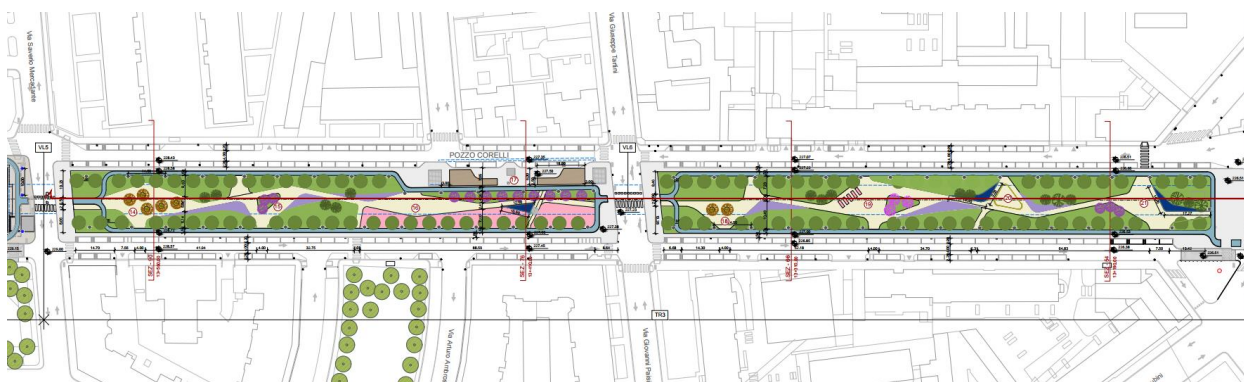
Planimetria TR3 tra Stazione San Giovanni Bosco e Stazione Corelli
